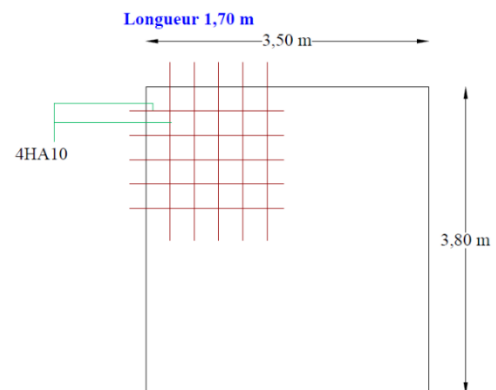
Schéma du ferrailage en travée des dalles. (Nappes supérieur).
